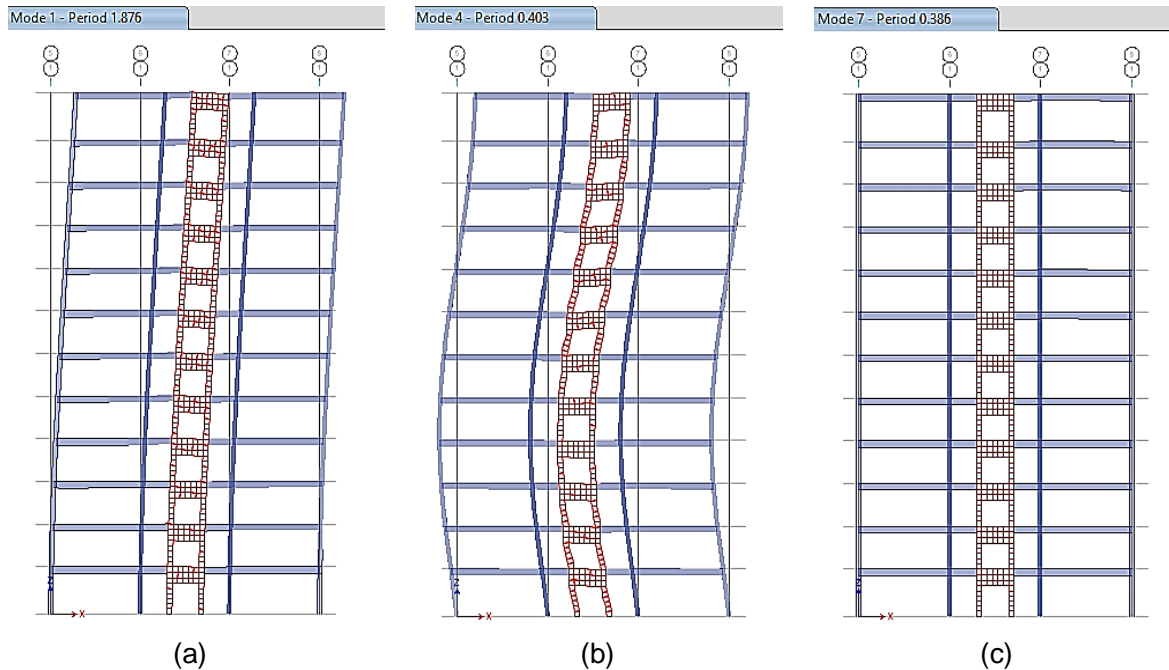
Vista de elevación. Modos de vibración 1, 4 y 7 de la estructura A respectivamente.
